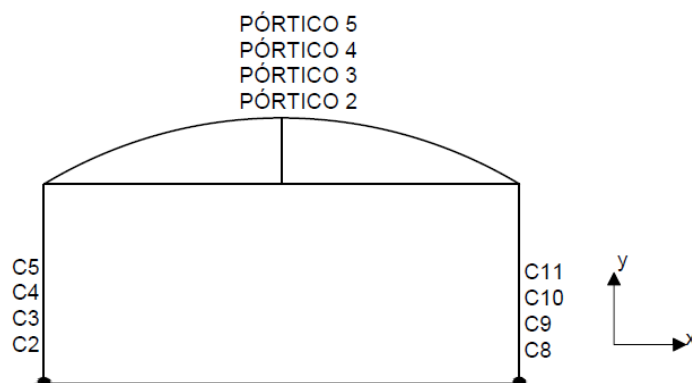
Figura que evidencia las llamadas "Columnas Centrales"
